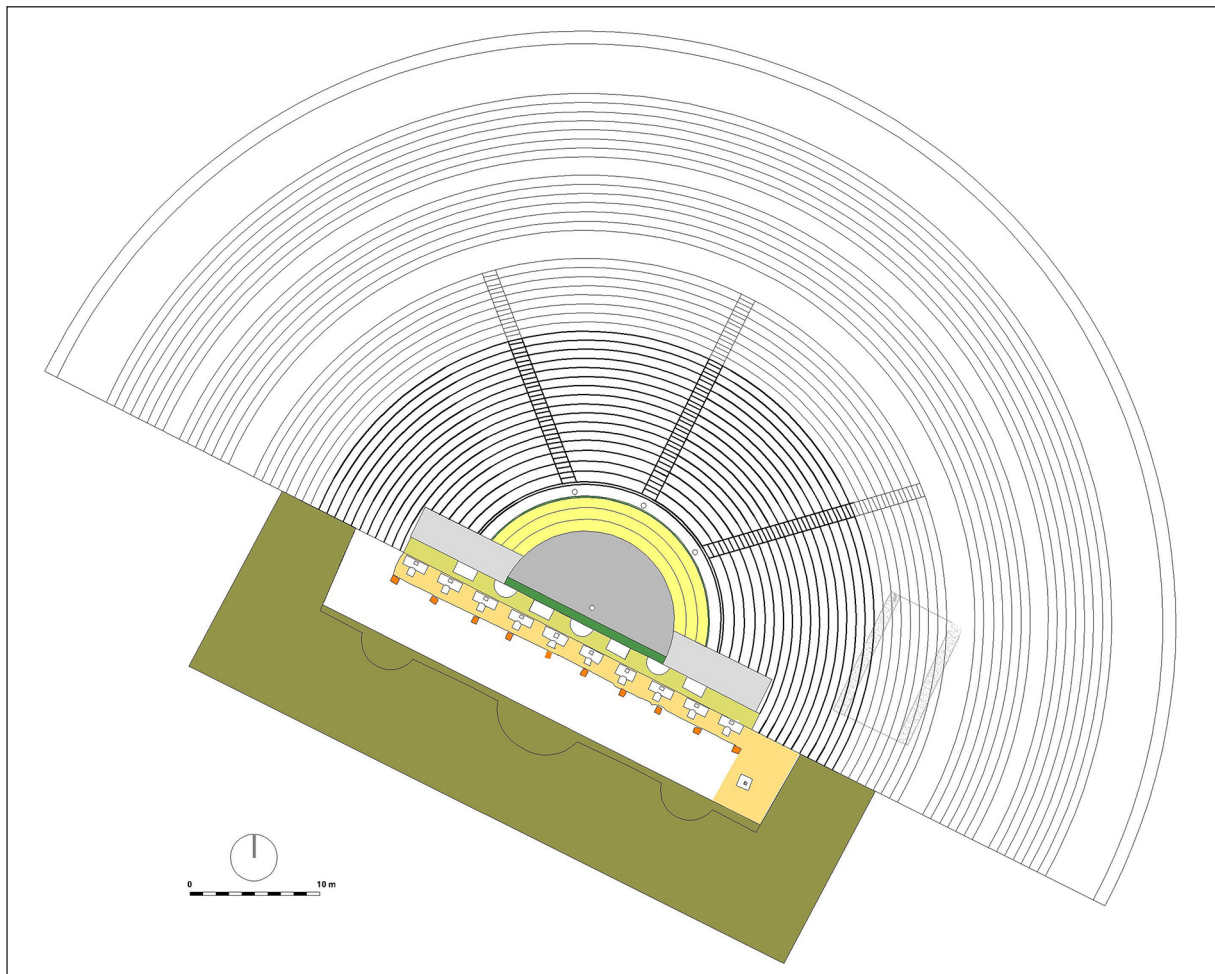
Reconstrucció hipotètica de la planta del teatre.
